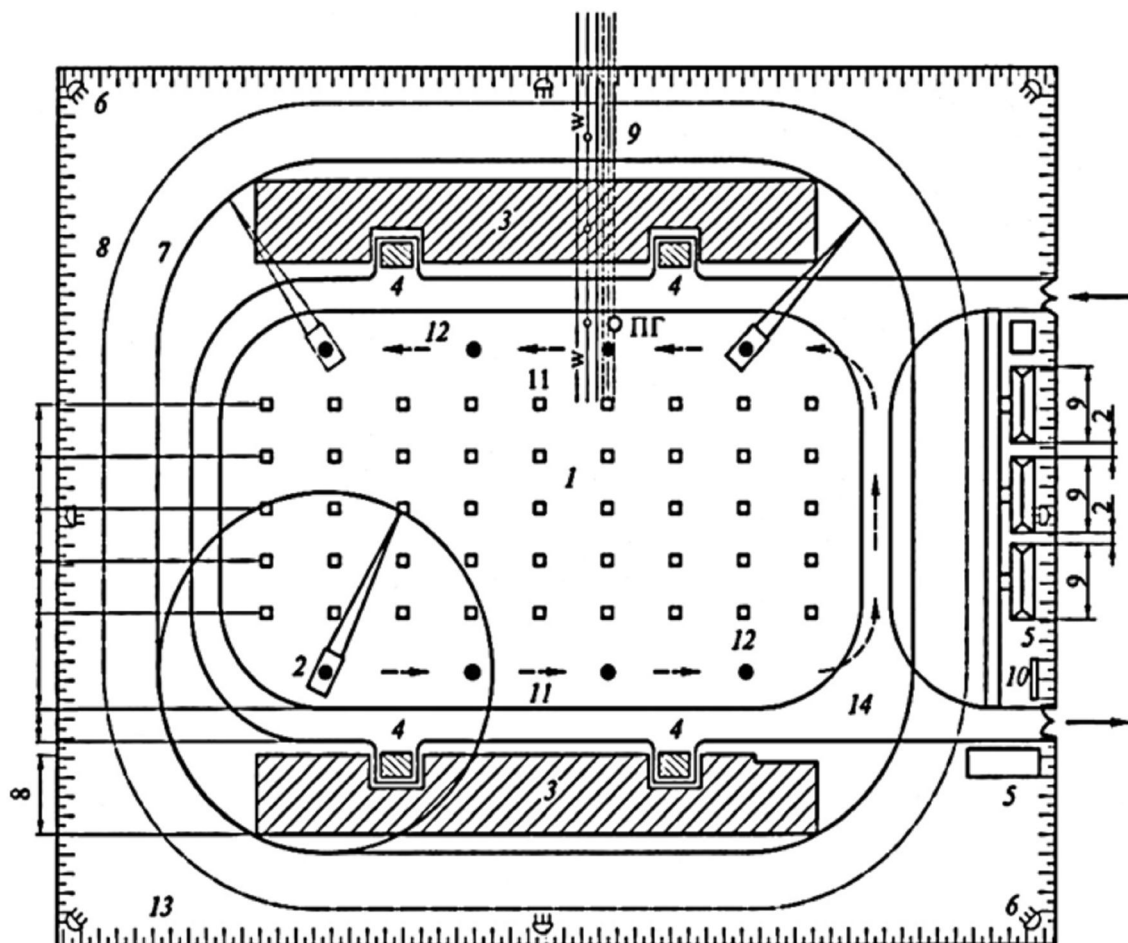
Строительный генеральный план одноэтажного многопролетного промышленного здания
